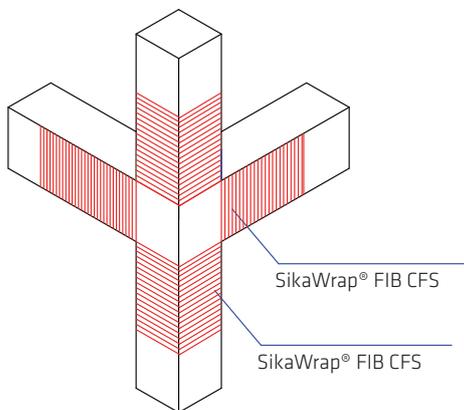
Fase 3 e 4: Rinforzo con confinamento estremità pilastri con tessuto unidirezionale in avvolgimento della sezione e incremento resistenza al taglio delle estremità delle travi con SikaWrap® FIB
